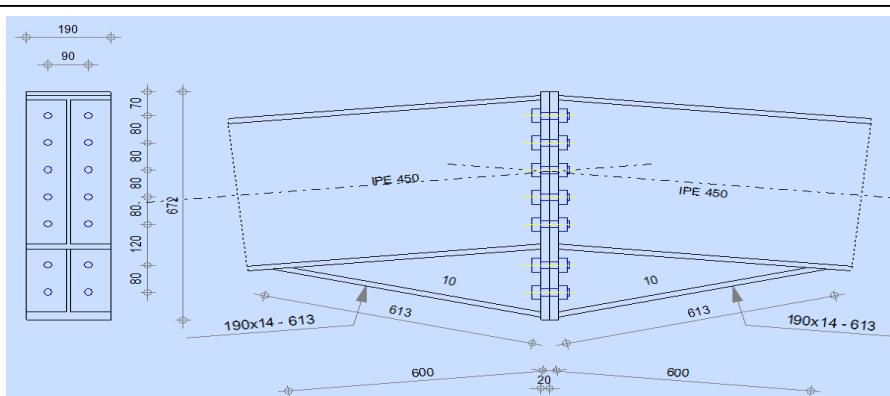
Détail de l'assemblage au niveau de faîtage
